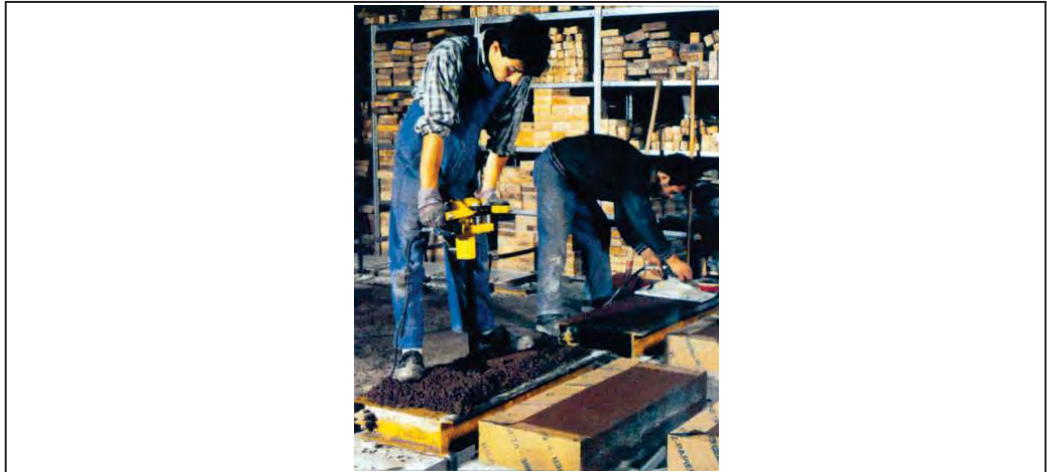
APISONADORAS VIBRATORIAS Y TALOCHAS VIBRATORIAS ELÉCTRICAS – Son equipos ideales para la compactación al detalle de elementos de concreto fabricados en un puesto de precolados - *Fuente: La vibración del concreto – CERIB, p. 69
